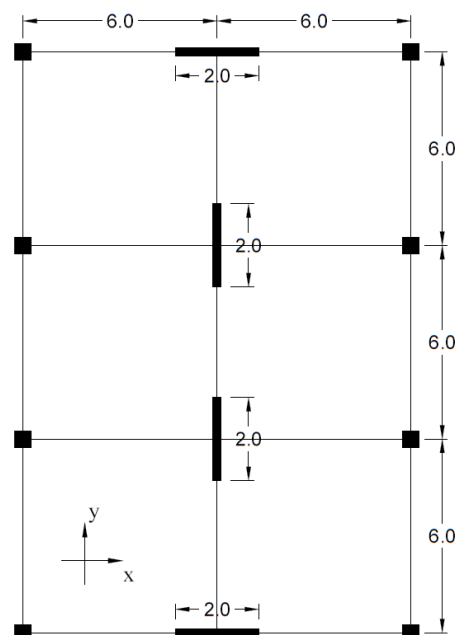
Esquema em planta do exemplo de estrutura mista
